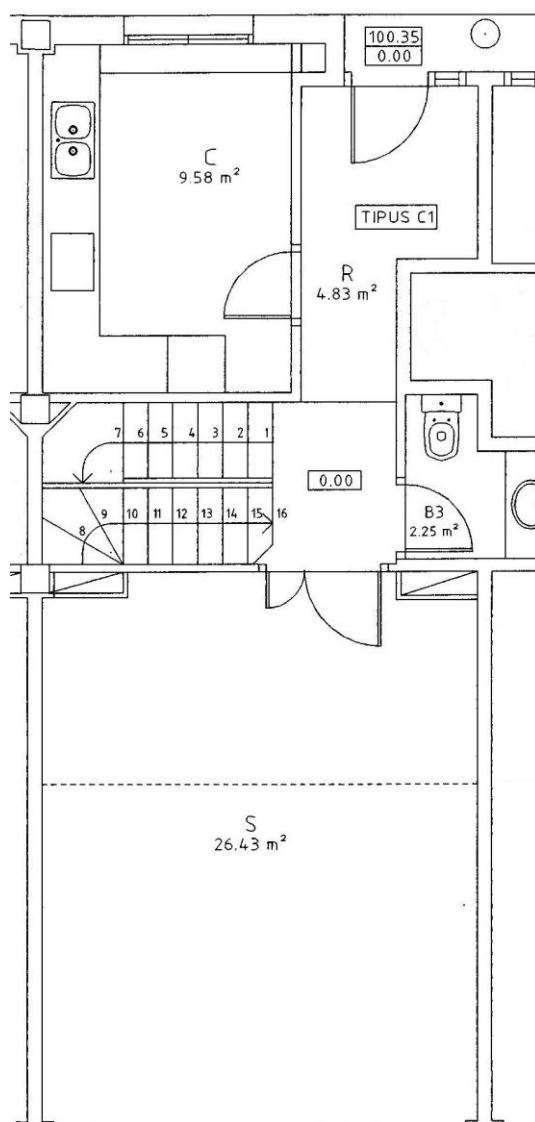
Plano de la planta baja (memoria de calidades de la vivienda).
